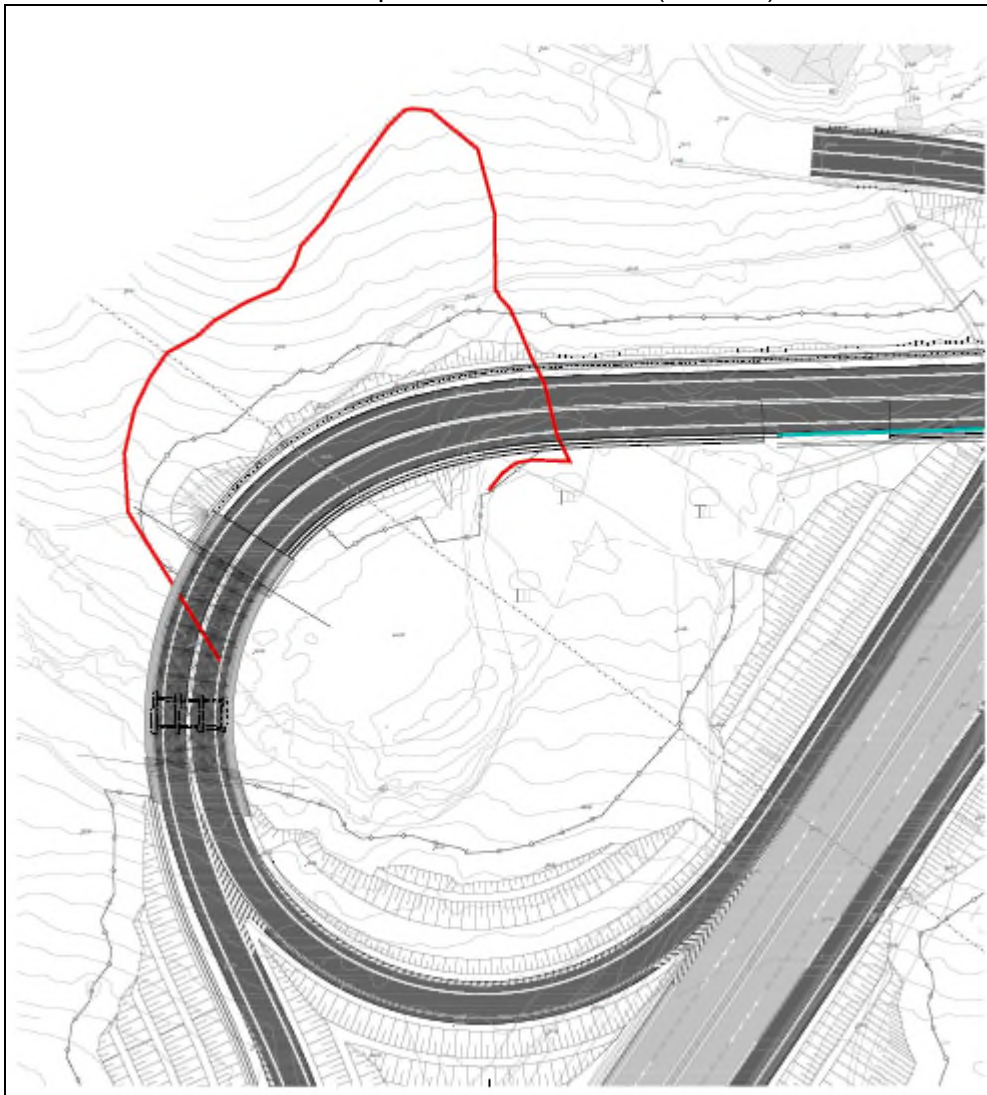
Planimetria ramo Genova – Casello_da Ponte Bossarino1 a Sottovia
